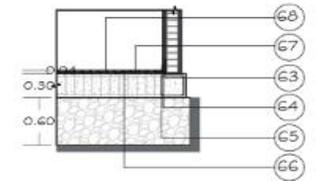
Detalle 14 (Piso)-Esc:1/20. Fuente: Elaboración Propia.
